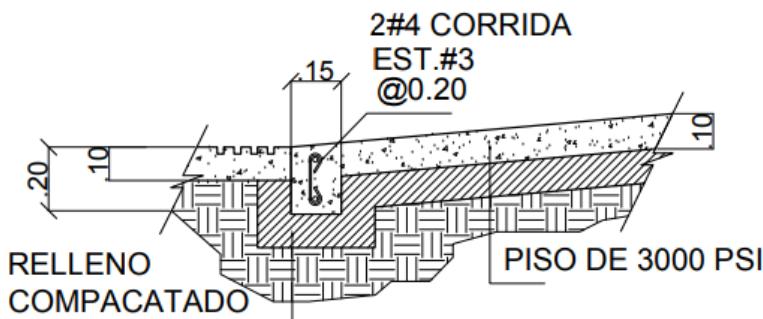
Detalle de rampa. Fuente: Plano de anteproyecto
